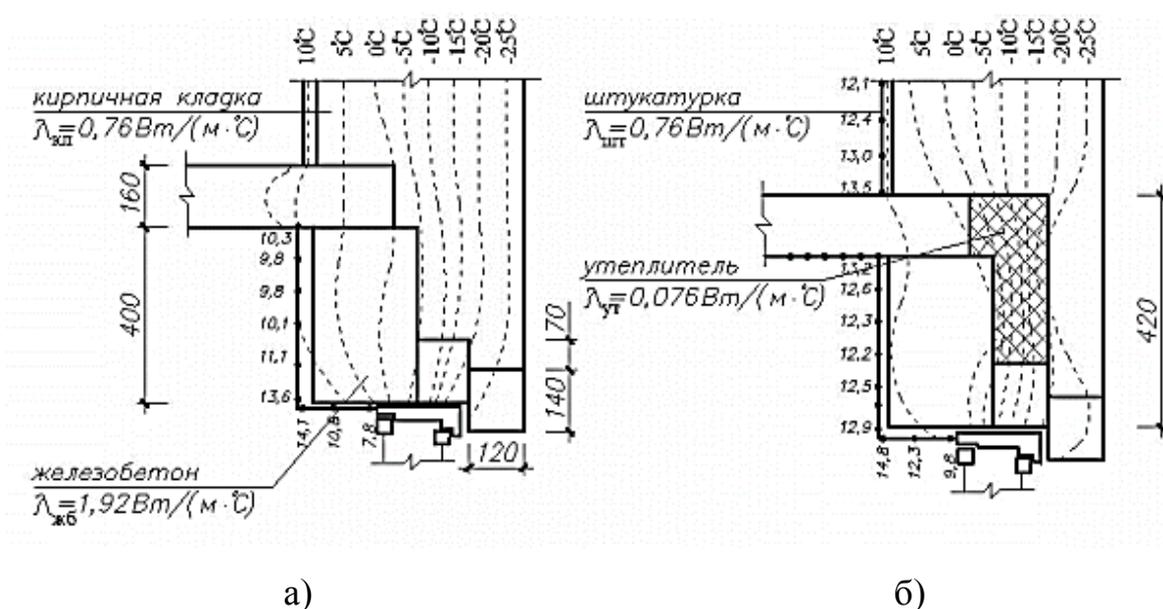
Температурные поля в месте опирания плит перекрытия на обвязочную балку: а) без устройства утепления; б) при утеплении минеральной ватой
